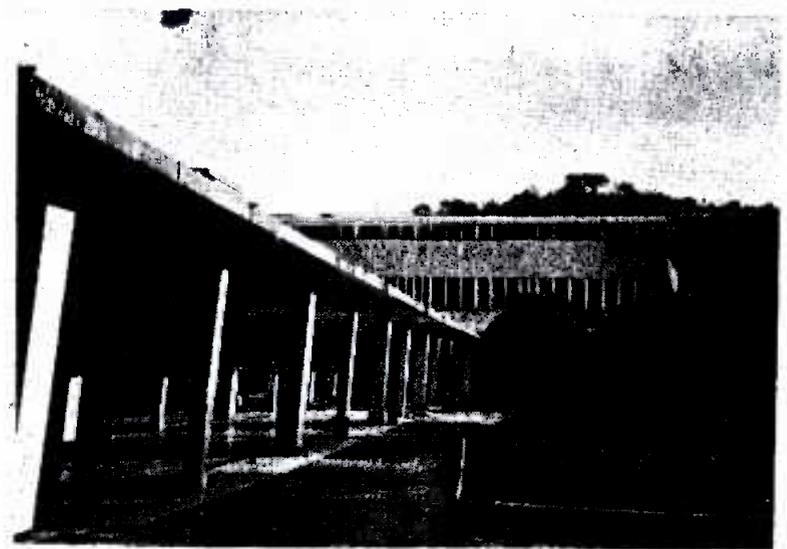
Colegio Salesiano Ricaldi (CSR). Al fondo el bloque de 3 pisos. En el 1er. plano el pasadizo techado. Note los daños y las columnas reforzadas de mayor sección.
